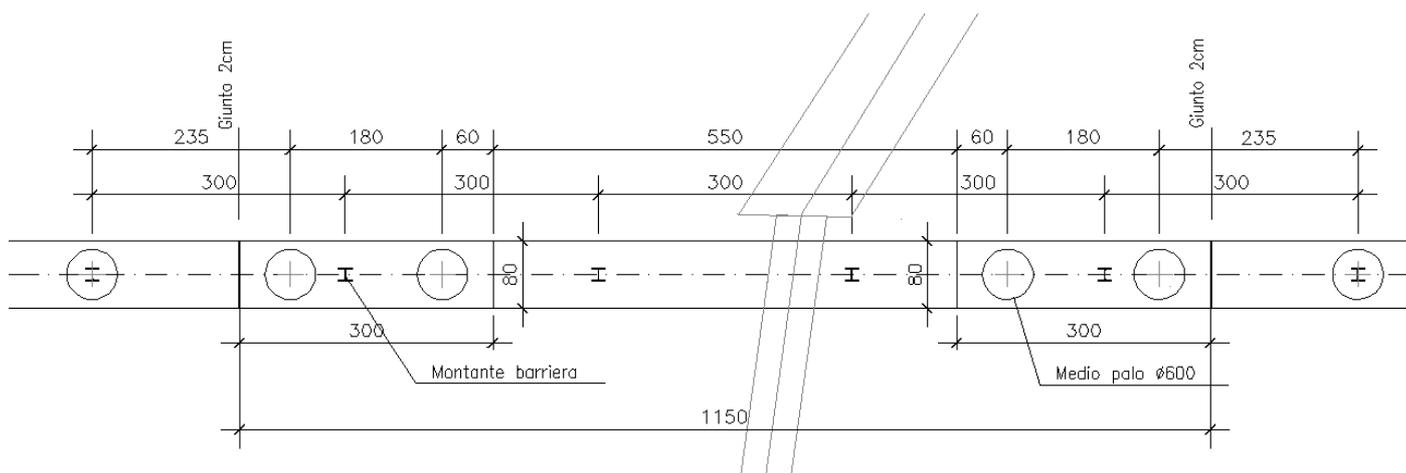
Fondazione scavalco L= 5.5 m - Pianta
